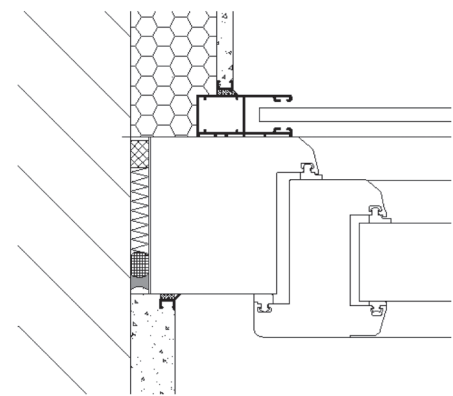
Anschlussdetail mit Führungsschiene A3 - R
